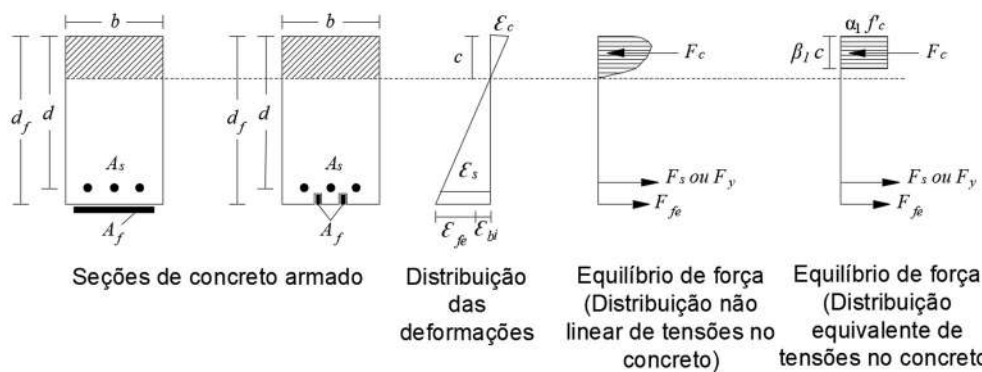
Resistência seccional de vigas sob flexão no ELU. ACI 440-2R (2017).
